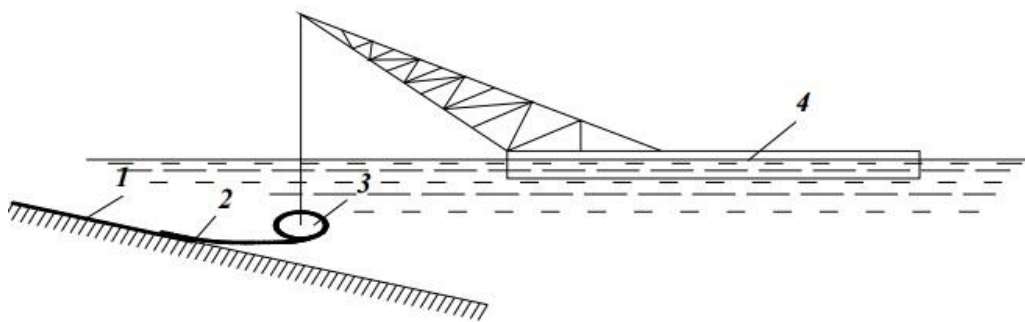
Укладка асфальтобетонного покрытия:
